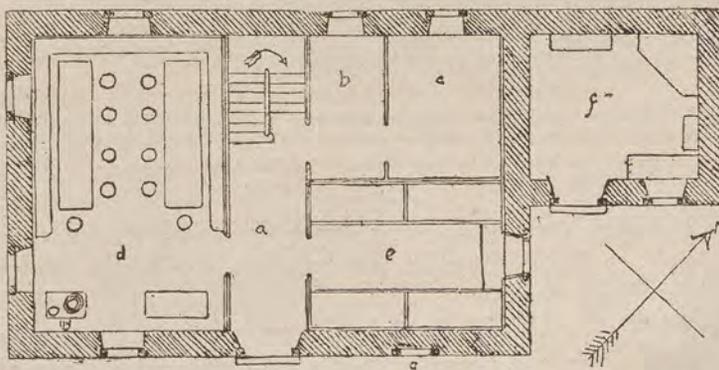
Pianta del pianterreno del Rifugio S. Marco.
